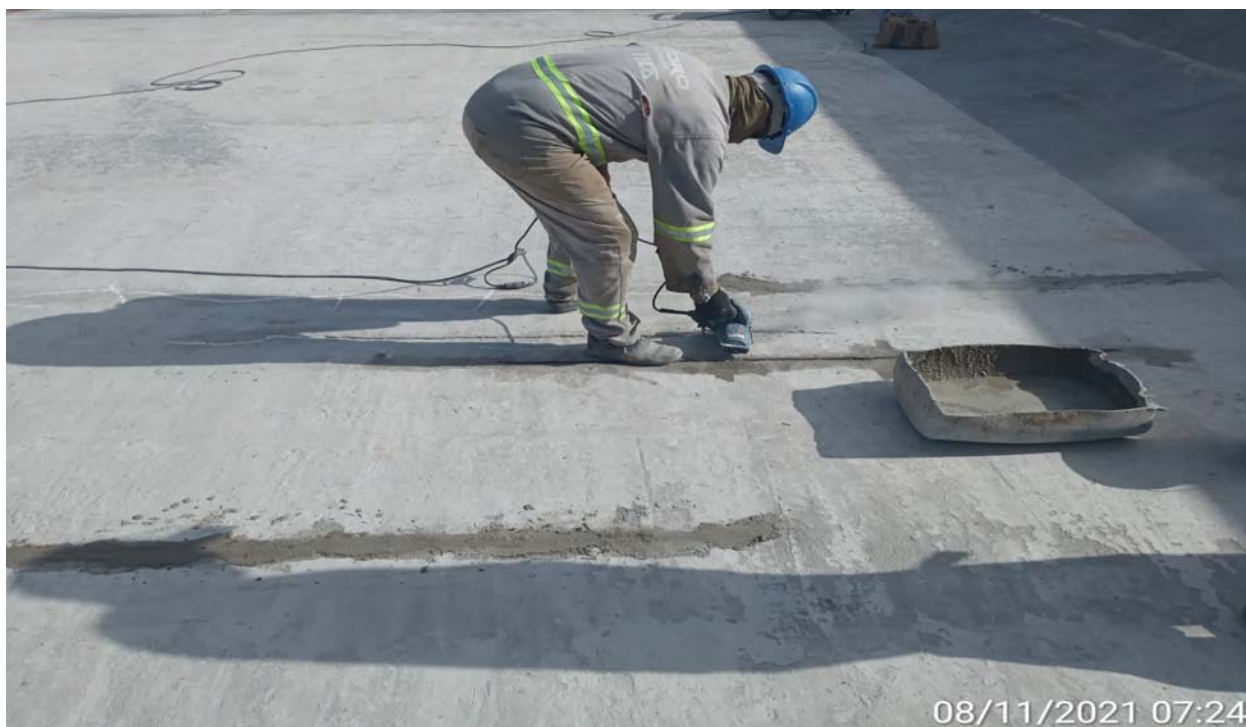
Execução de tratamento nas micro fissuras da laje da bacia de dissipação
